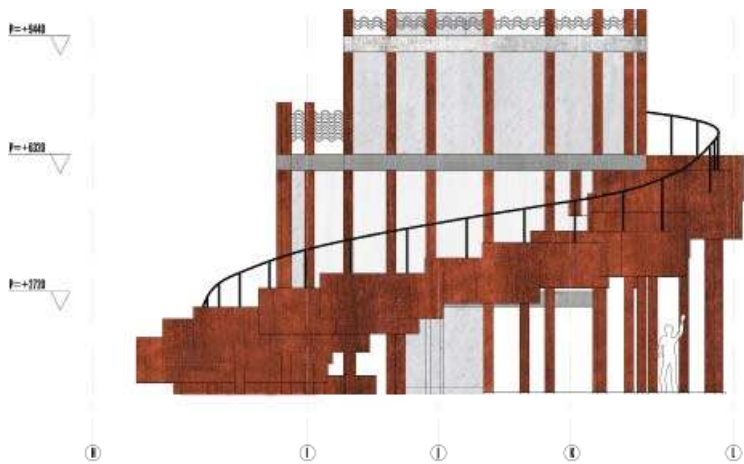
Doorsnede, 1:100, "Boskiek'n"
